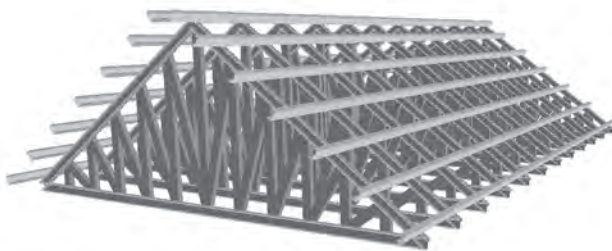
,1. Estructura recomendada por los fabricantes de los materiales constructivos.
